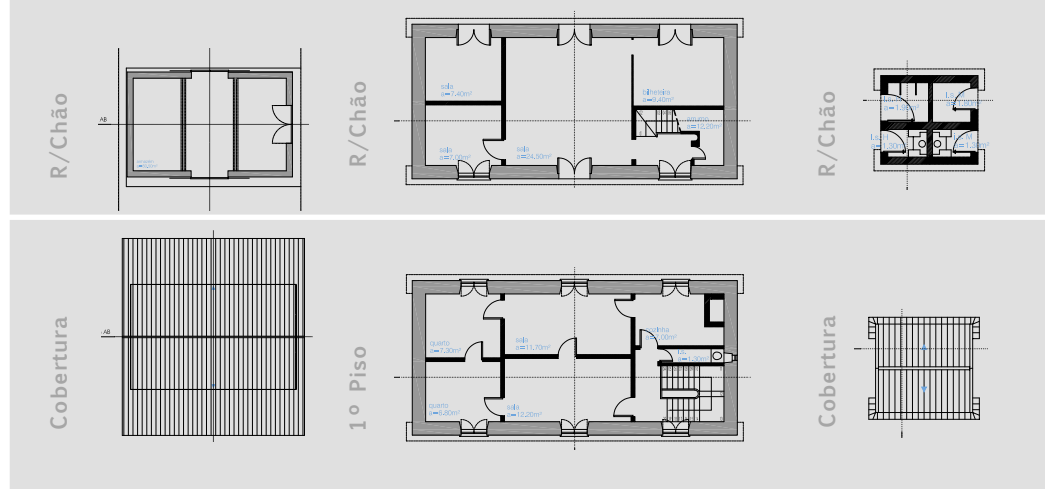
Plantas do armazém, estação e das I.S. antes da intervenção
